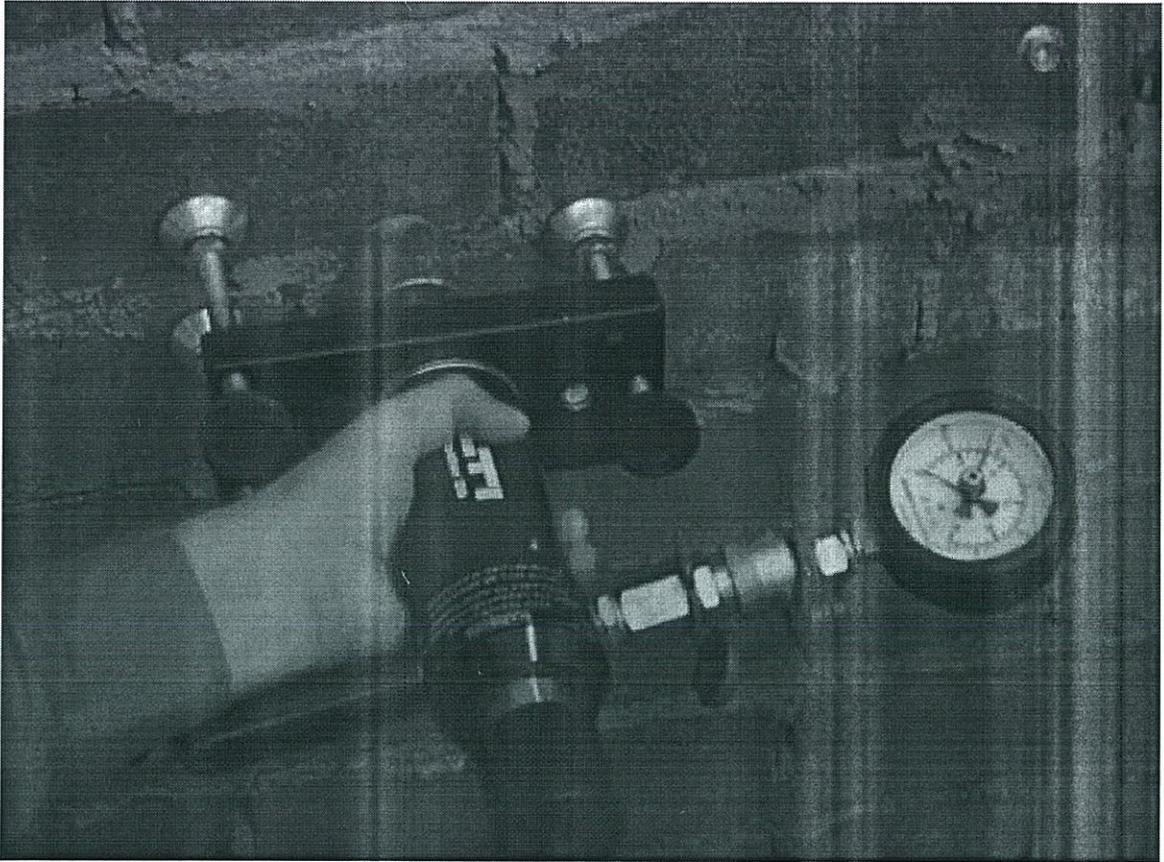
Испытание анкера марки HRD, закреплённого в горизонтальный растворный шов кладки из вибропрессованного бетонного кирпича
